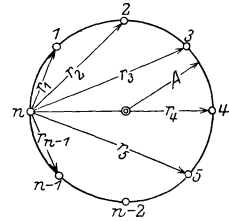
Mehrbrunnenanlage von kreisförmigem Grundriß mit einer Brunnenstafel in Betrieb.
